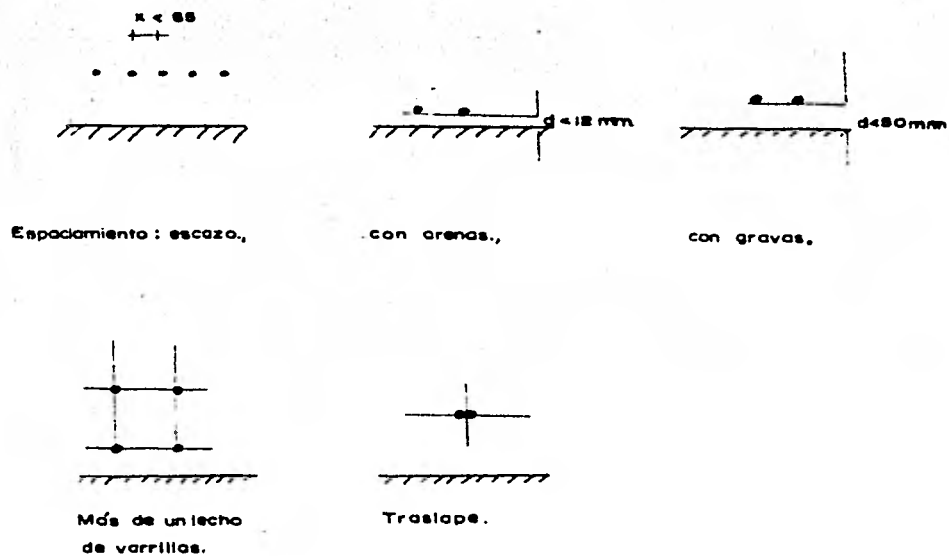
Forma incorrecto de colocar el acero de refuerzo en el concreto lanzado .
